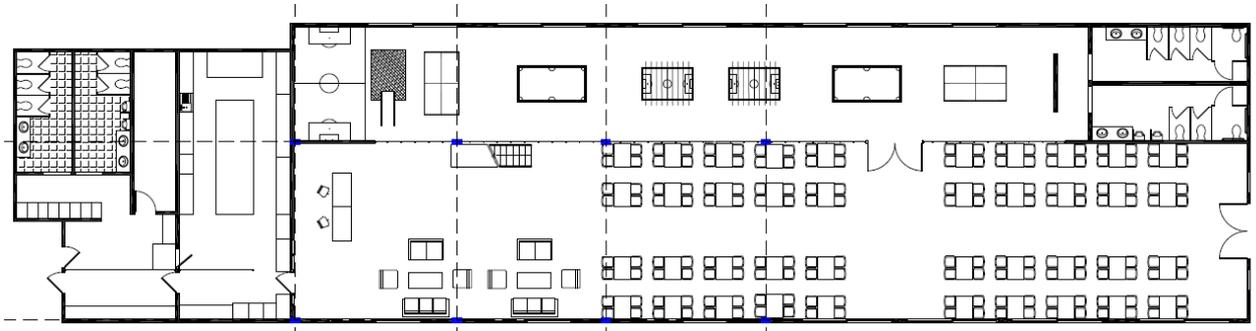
Plano en planta de restaurante. Fuente: Autores del proyecto.
